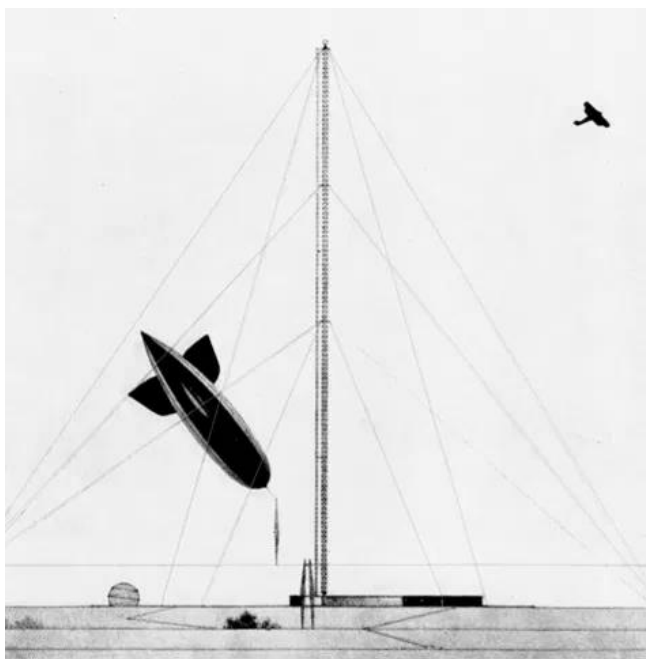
Дополнительное изображение фасада, найденное в сети
